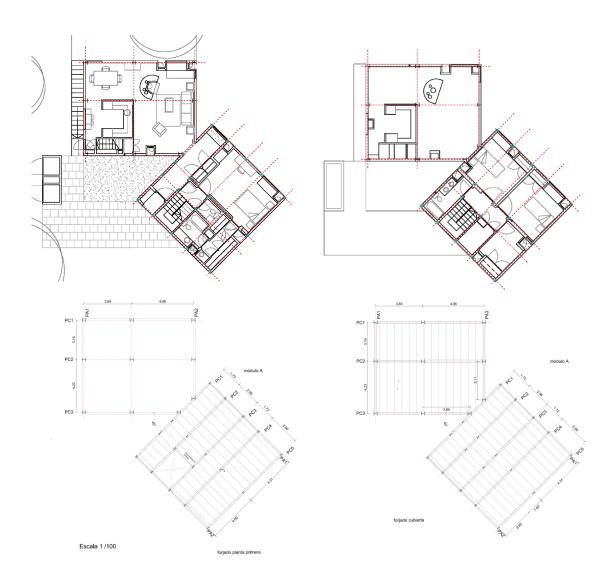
Ejemplo de uno de los proyectos de la casa Fisher: situación de pórticos y vigas en plantas arquitectónicas, y plantas de estructura
